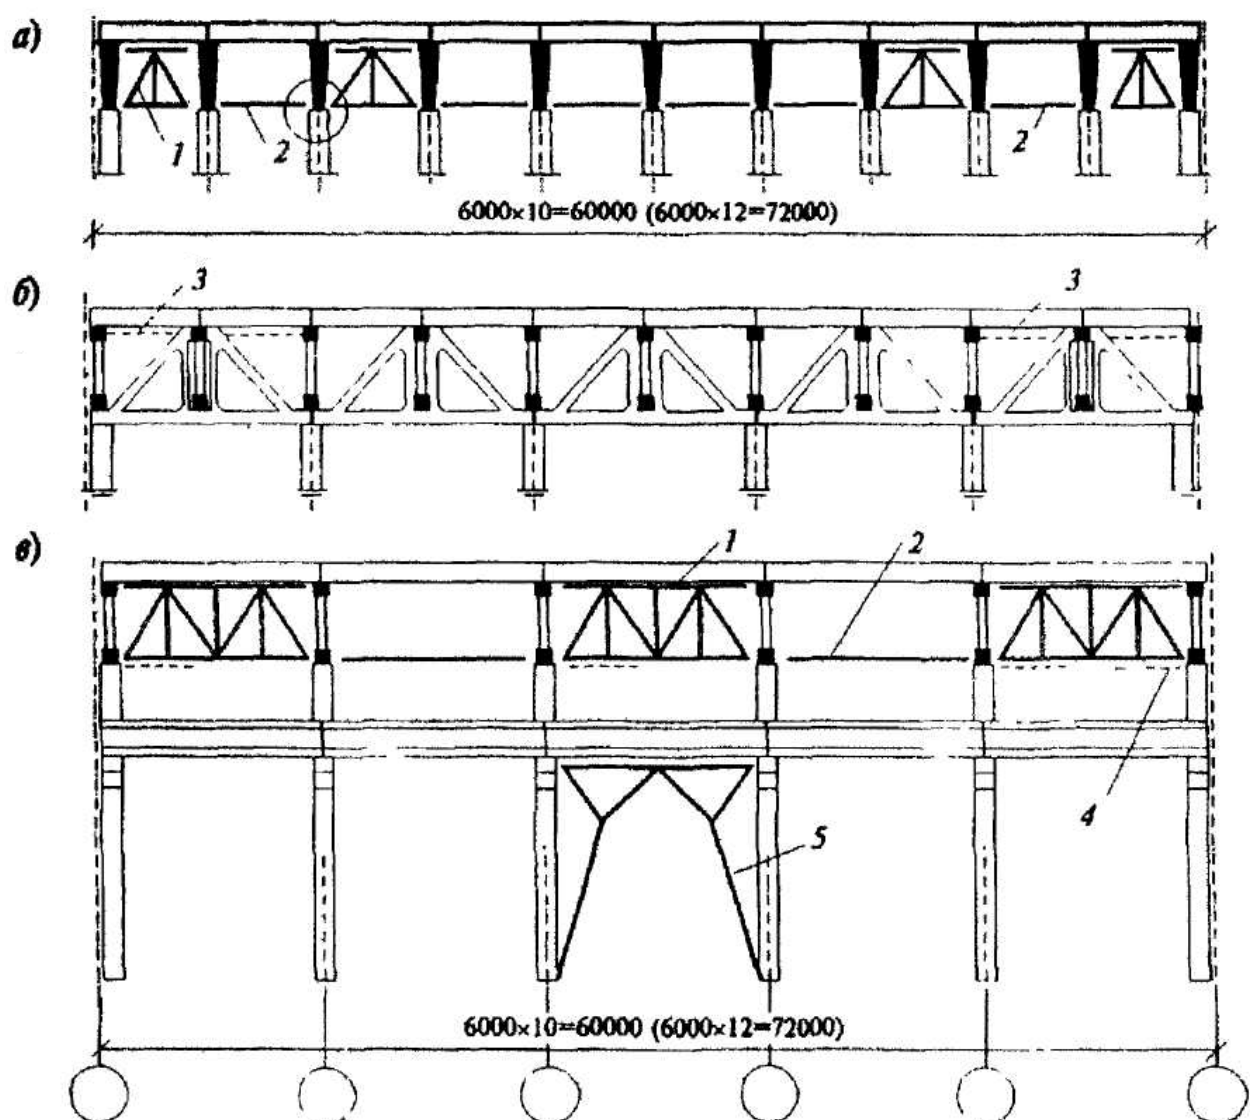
Связи в покрытиях при железобетонных стропильных конструкциях
